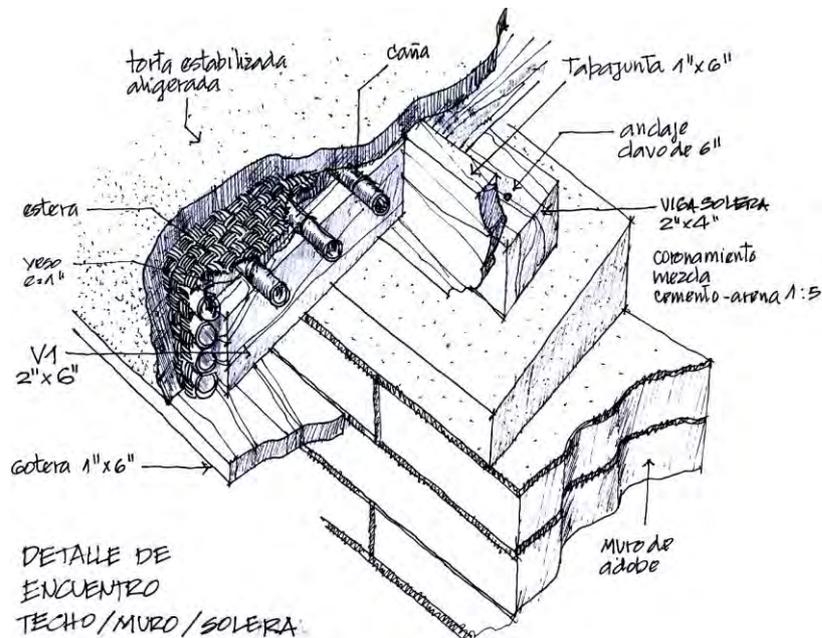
Se muestra coronamiento de muro, viga solera y elementos del techo de torta de barro.
